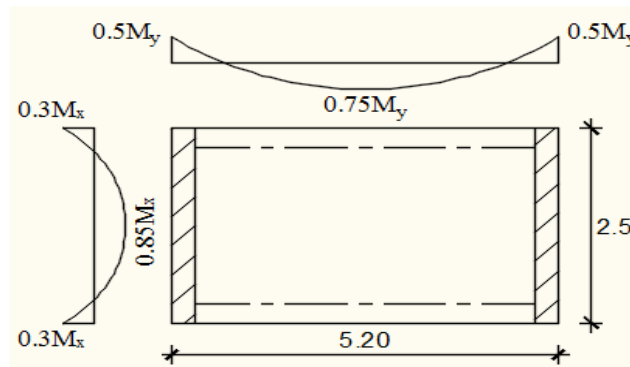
Schéma du panneau de la dalle appuyé sur 4 cotés.
